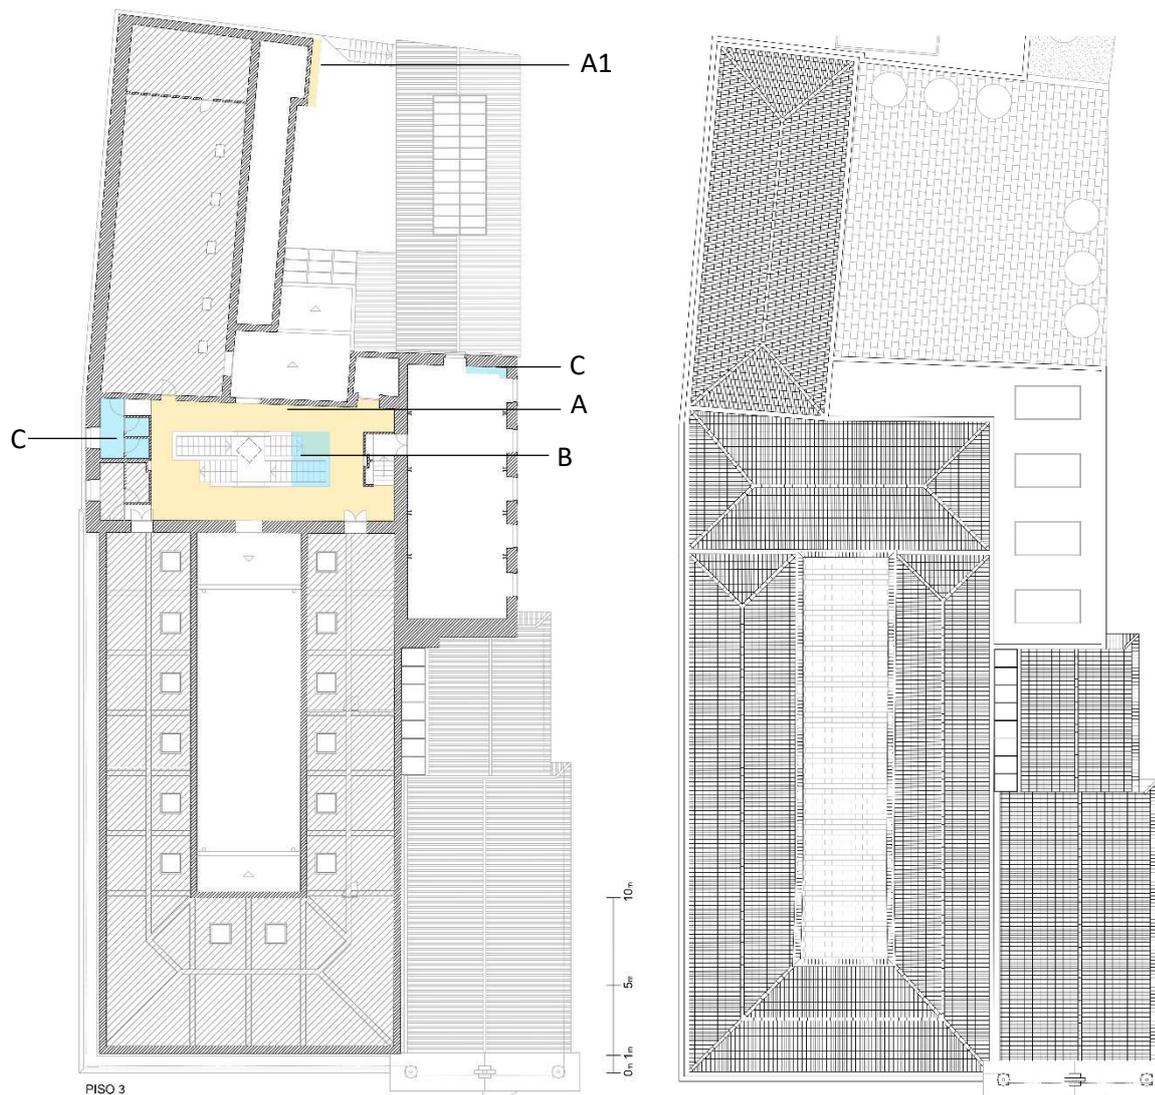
e 78 - Levantamento de patologias piso 3; Planta de Cobertura;
